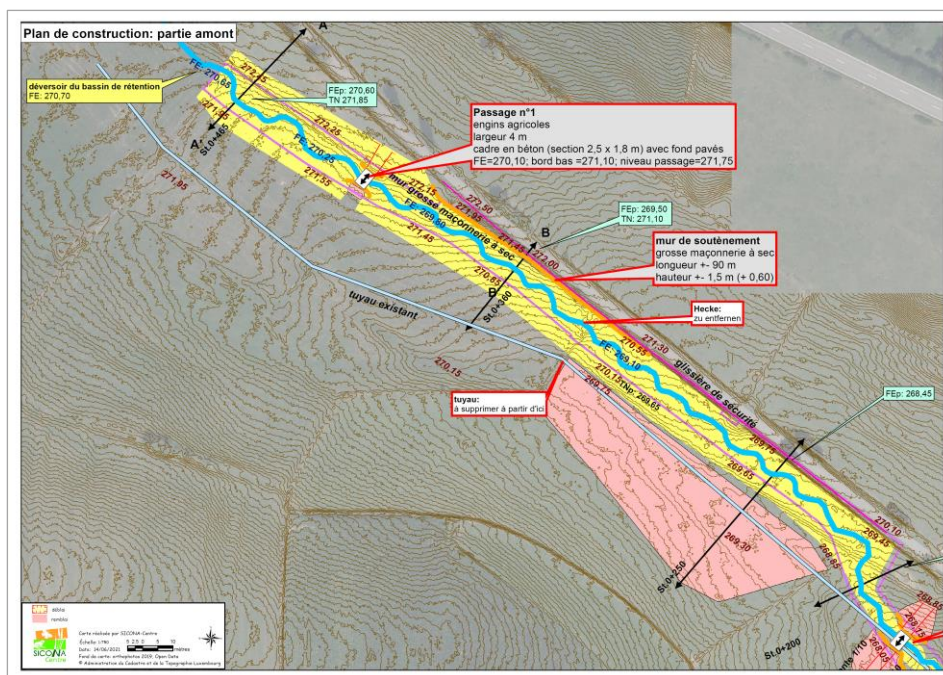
Aszug aus dem „plan de construction“ der Bachrenaturierung (o.M., genodert) Quelle: SICONA
